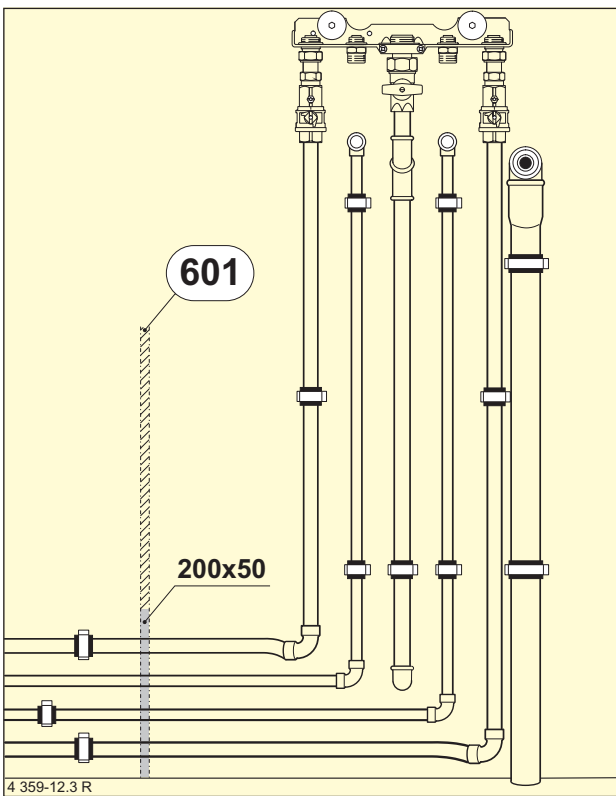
Bauseitige Aufputzverrohrung mit 60 mm Wandabstand
